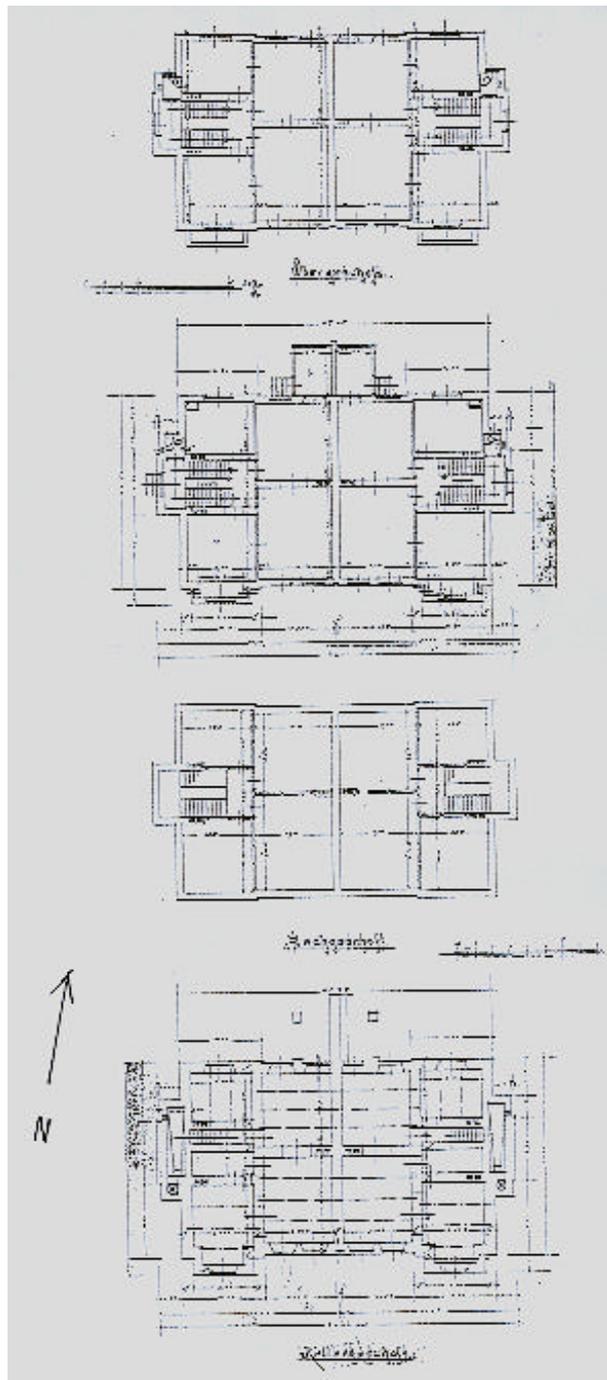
, Grundrisse Jaegerstraße 3/5
